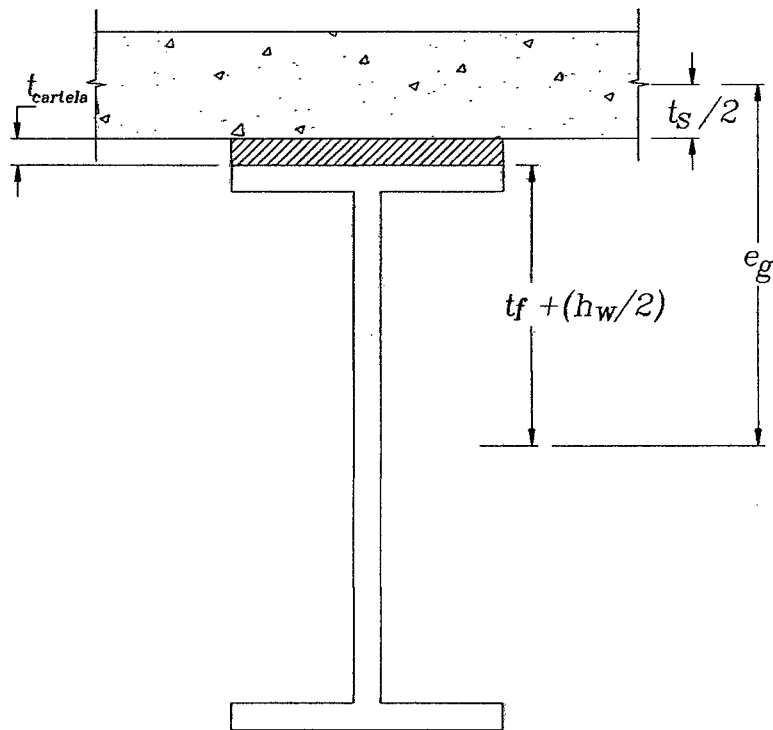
Distancia entre centros de gravedad de la viga y la losa.
